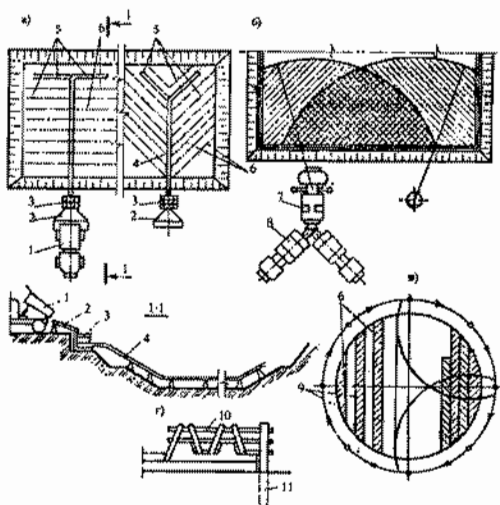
Схема укладки бетонной смеси бетононасосами и устройства опалубки дна: 1 - автосамосвал; 2 - вибробункер; 3 - бетононасос; 4 - бетоновод; 5 - места укладки бетононасосов в процессе бетонирования; 6 - рабочие швы в бетоне; 7 - автобетононасос; 8 - автобетоносмеситель; 9 - забетонированные полосы; 10 - ригель; 11 - свая
